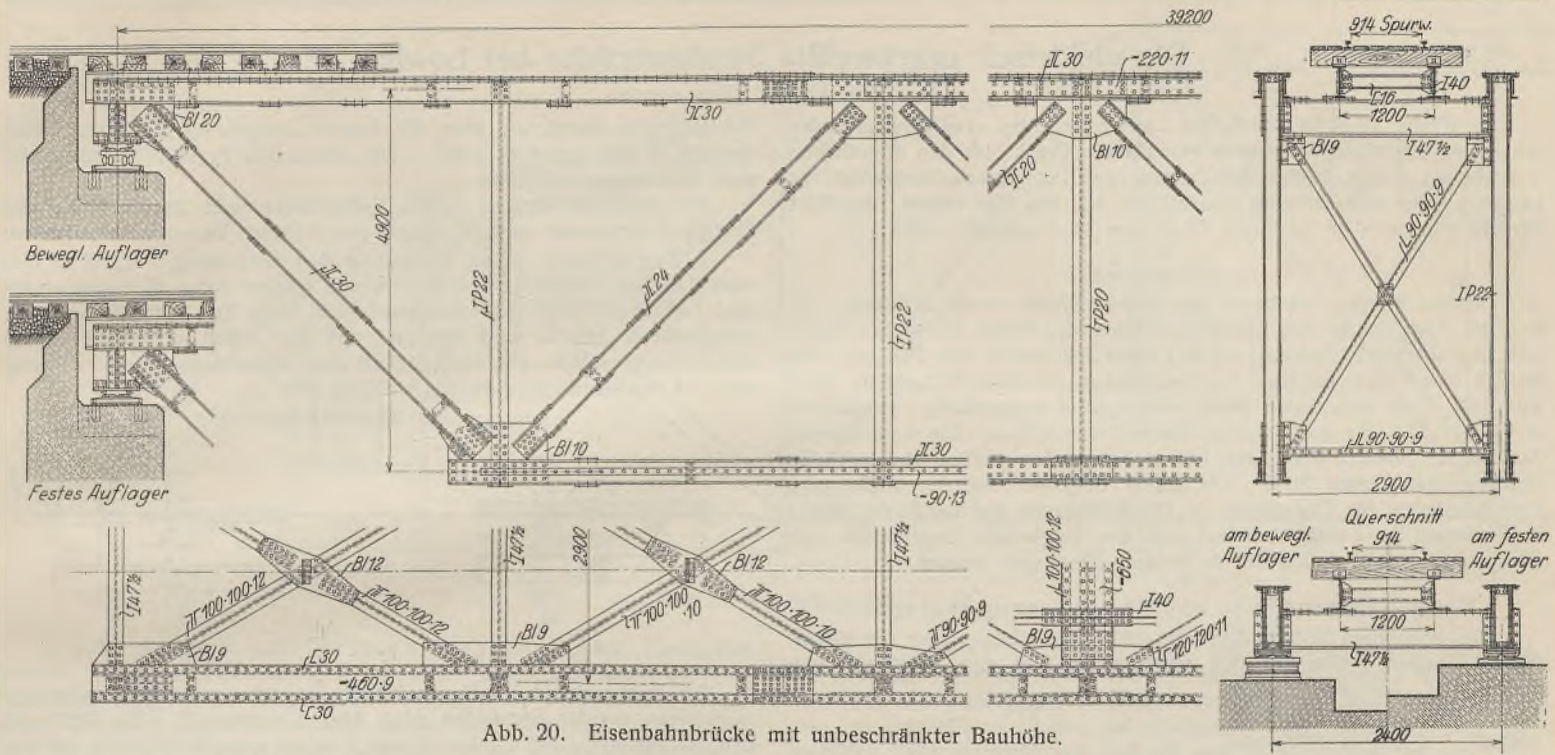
Eisenbahnbrücke mit unbeschränkter Bauhöhe.
